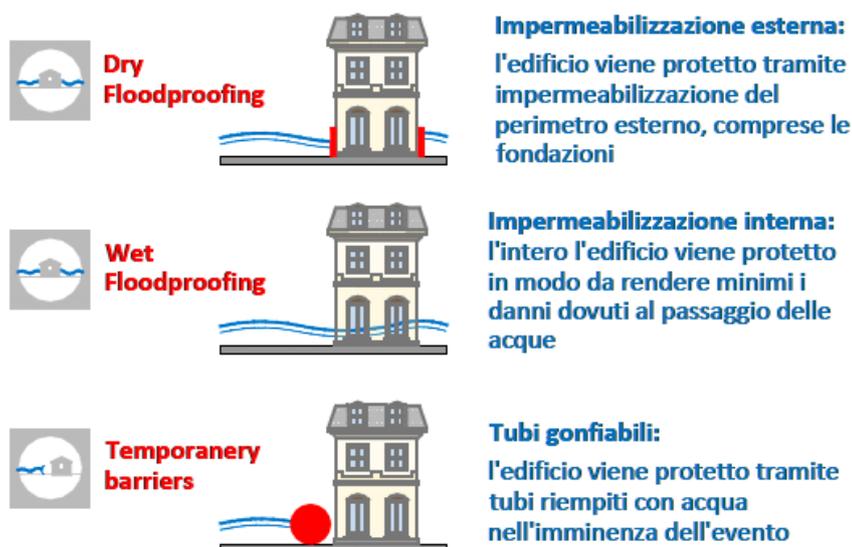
Principali misure di flood proofing (anti esondazione) degli edifici: dry floodproofing, wet floodproofing, barriere temporanee.
